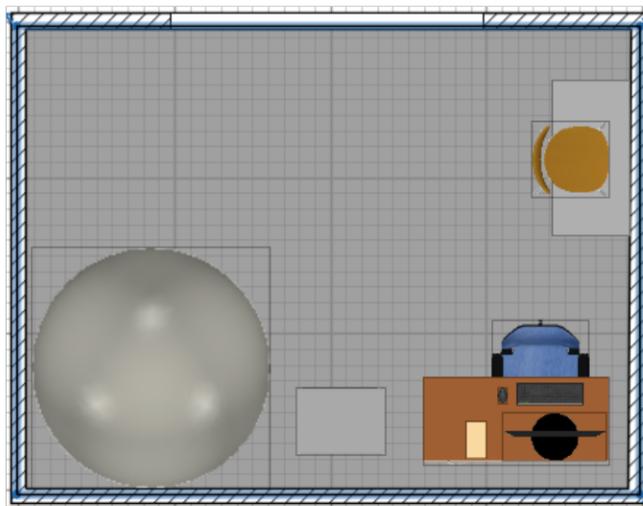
Plano de laboratorio de iluminación. AUTOCAD Ver.2018.
